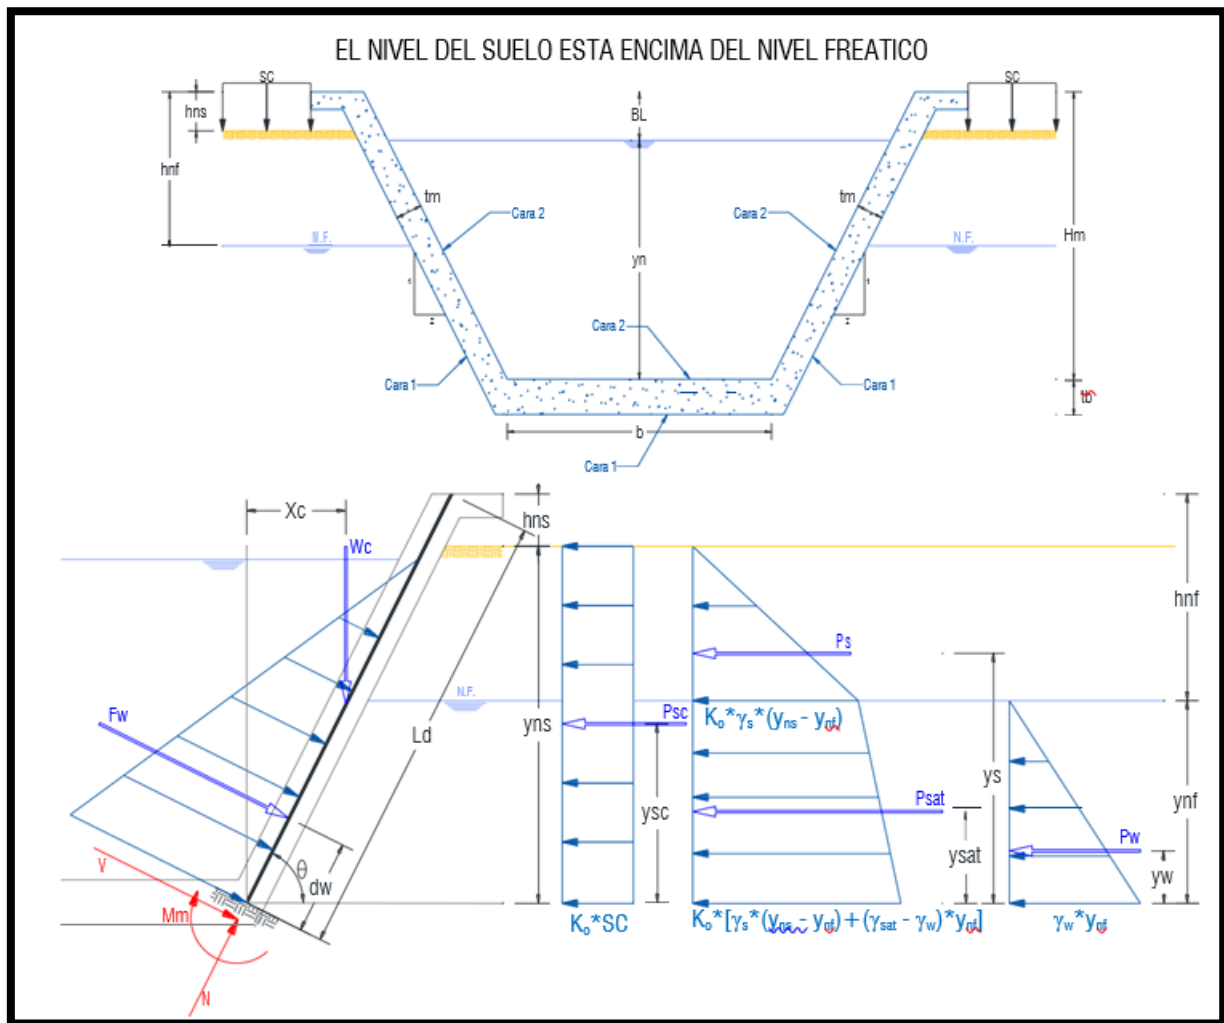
Vista de las cargas que se ejercen al muro de un canal típico (Elaboración propia)
